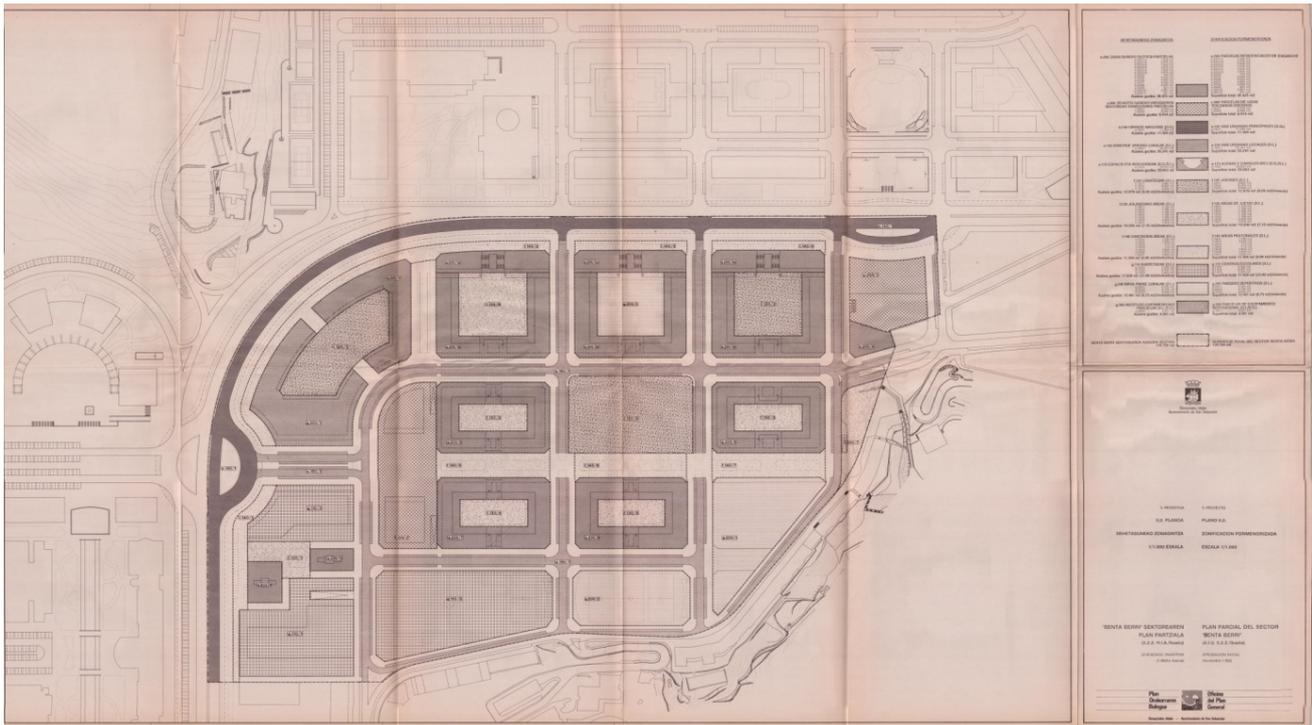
Plano II.2 de Zonificación Pormenorizada - P.P.O.P.G.
